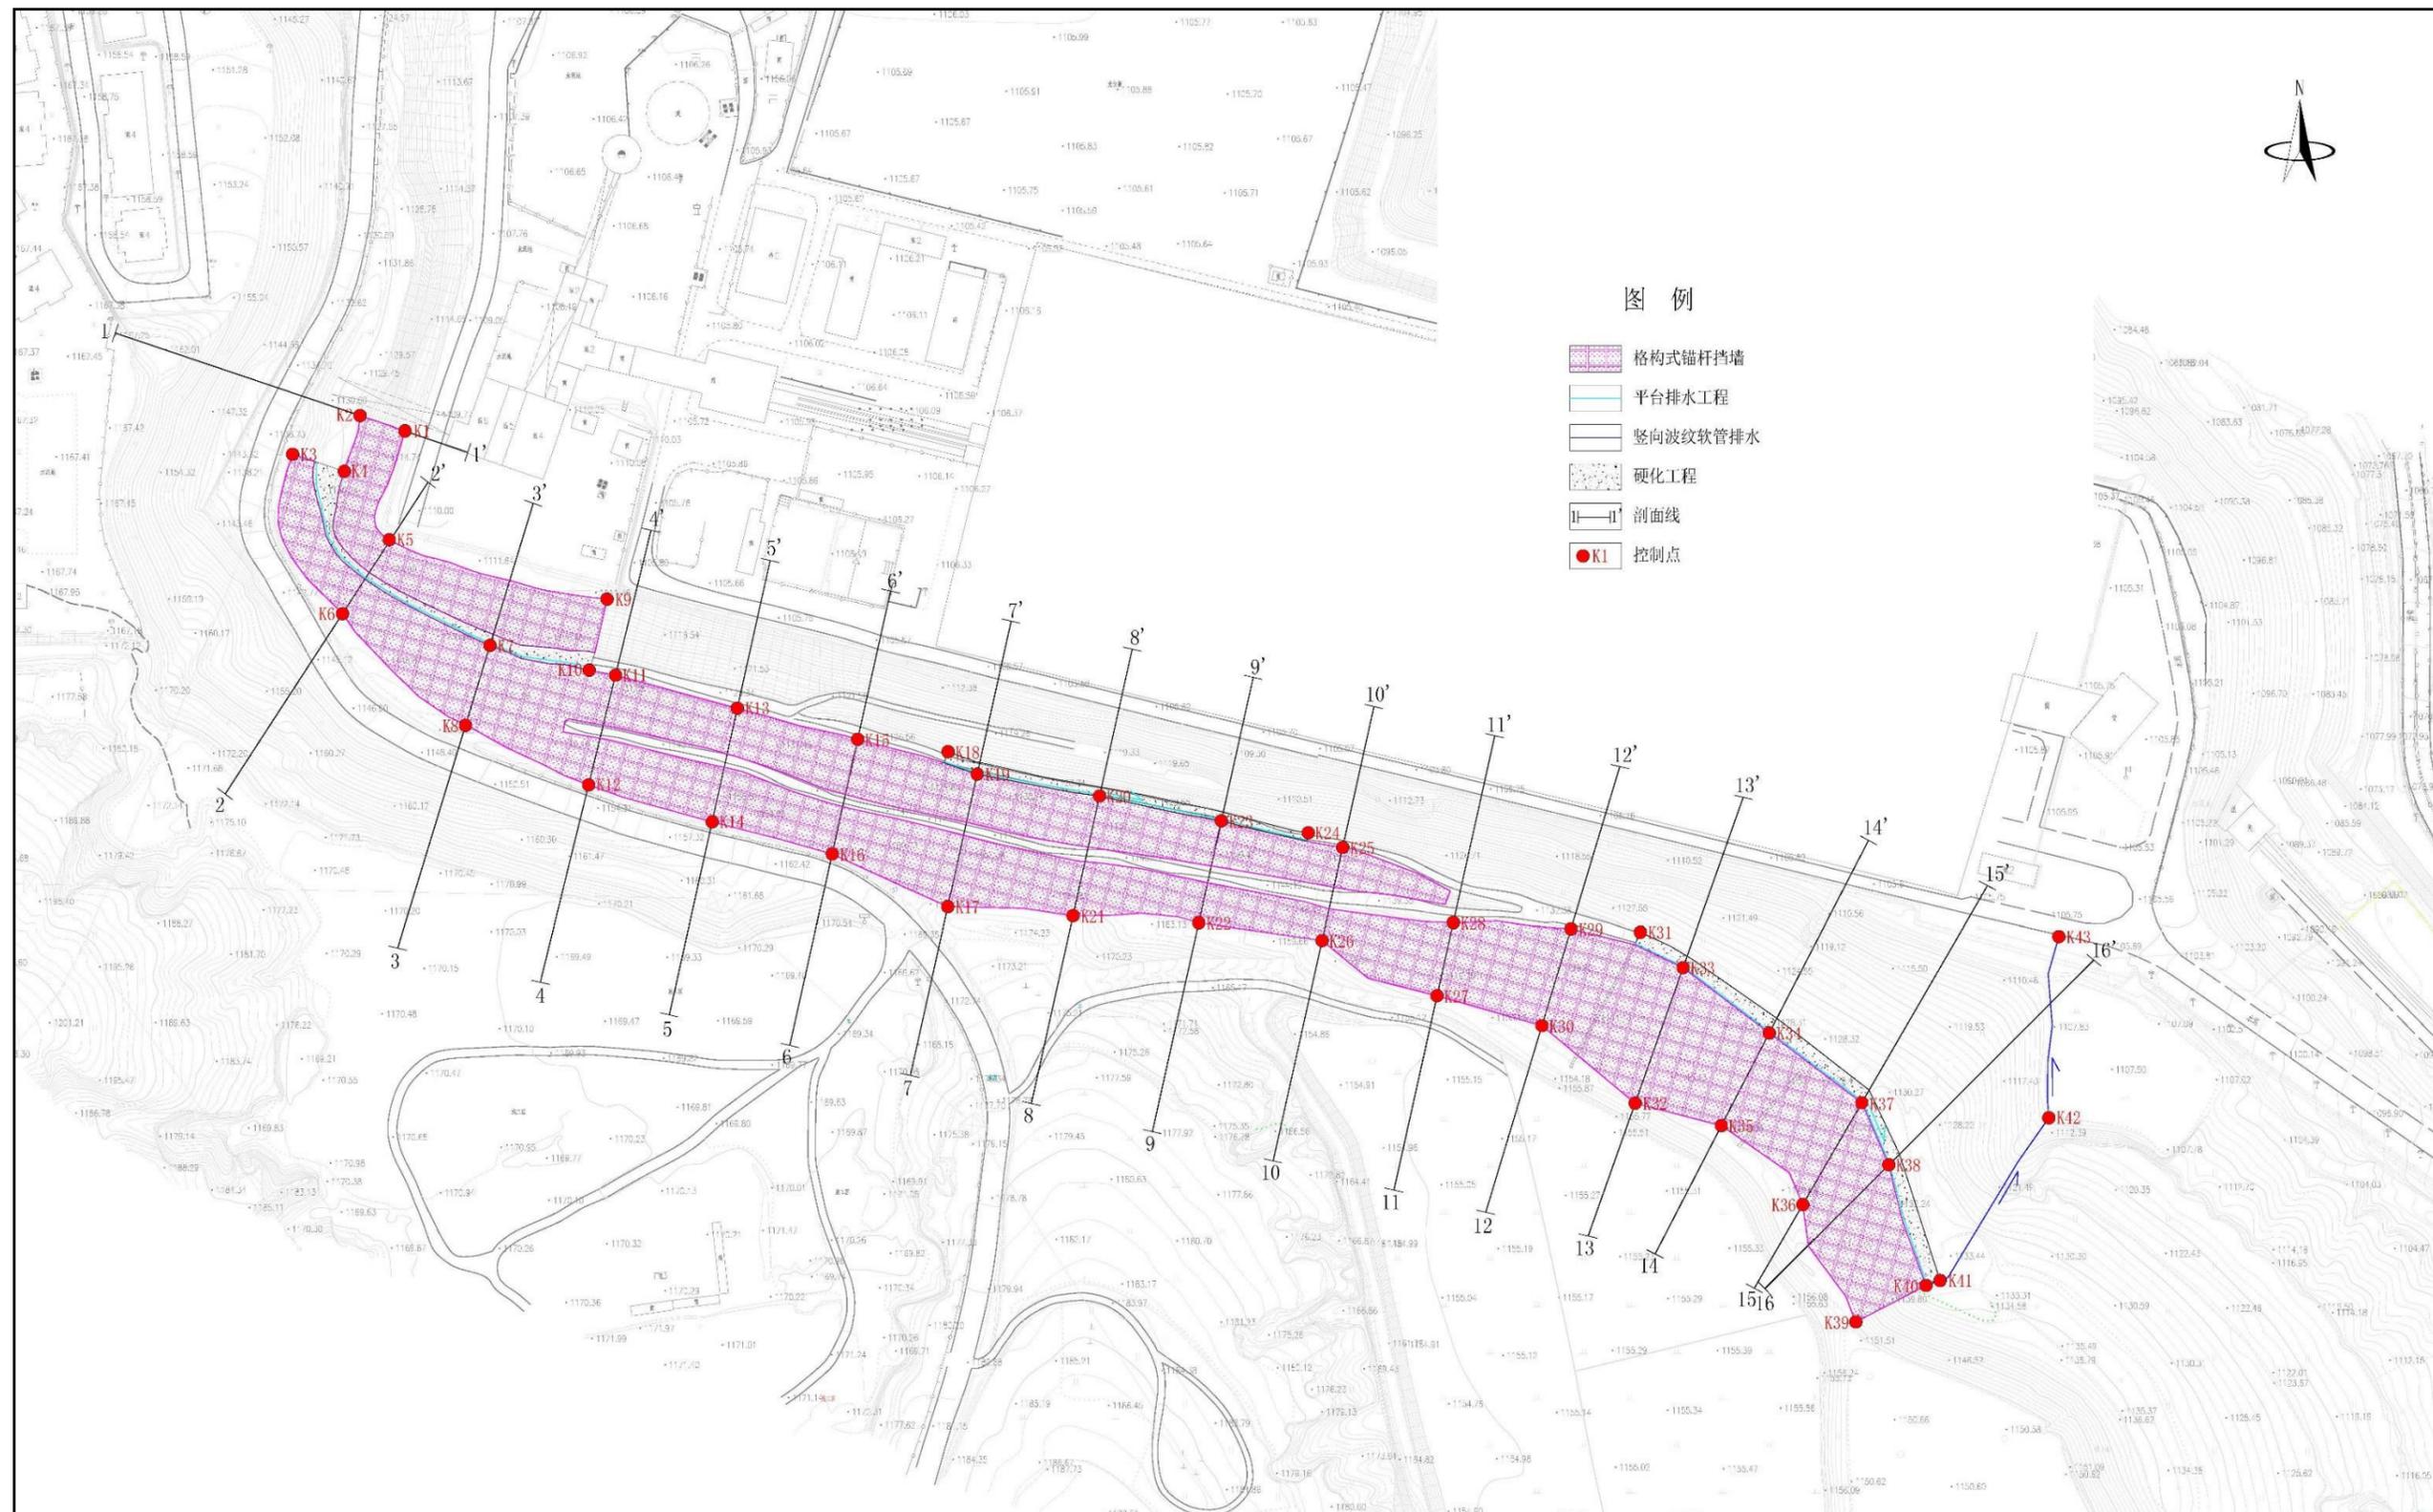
不稳定斜坡 P3 治理工程布置平面图
